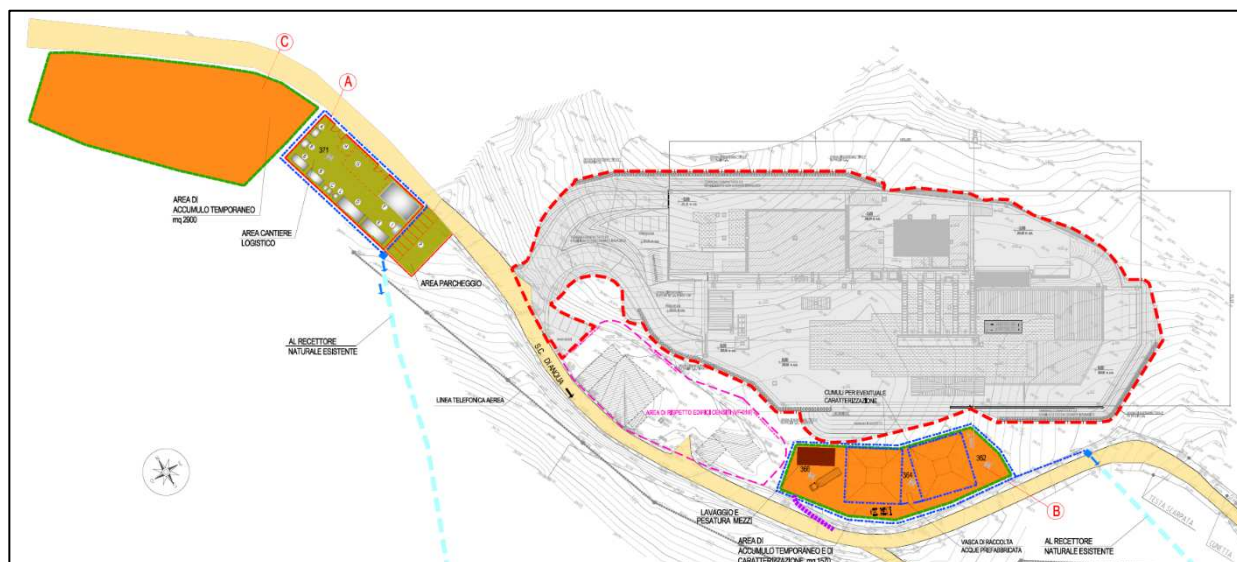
Planimetria e pianta cantiere civile - Stralcio della tavola R36045\_Pcant.
